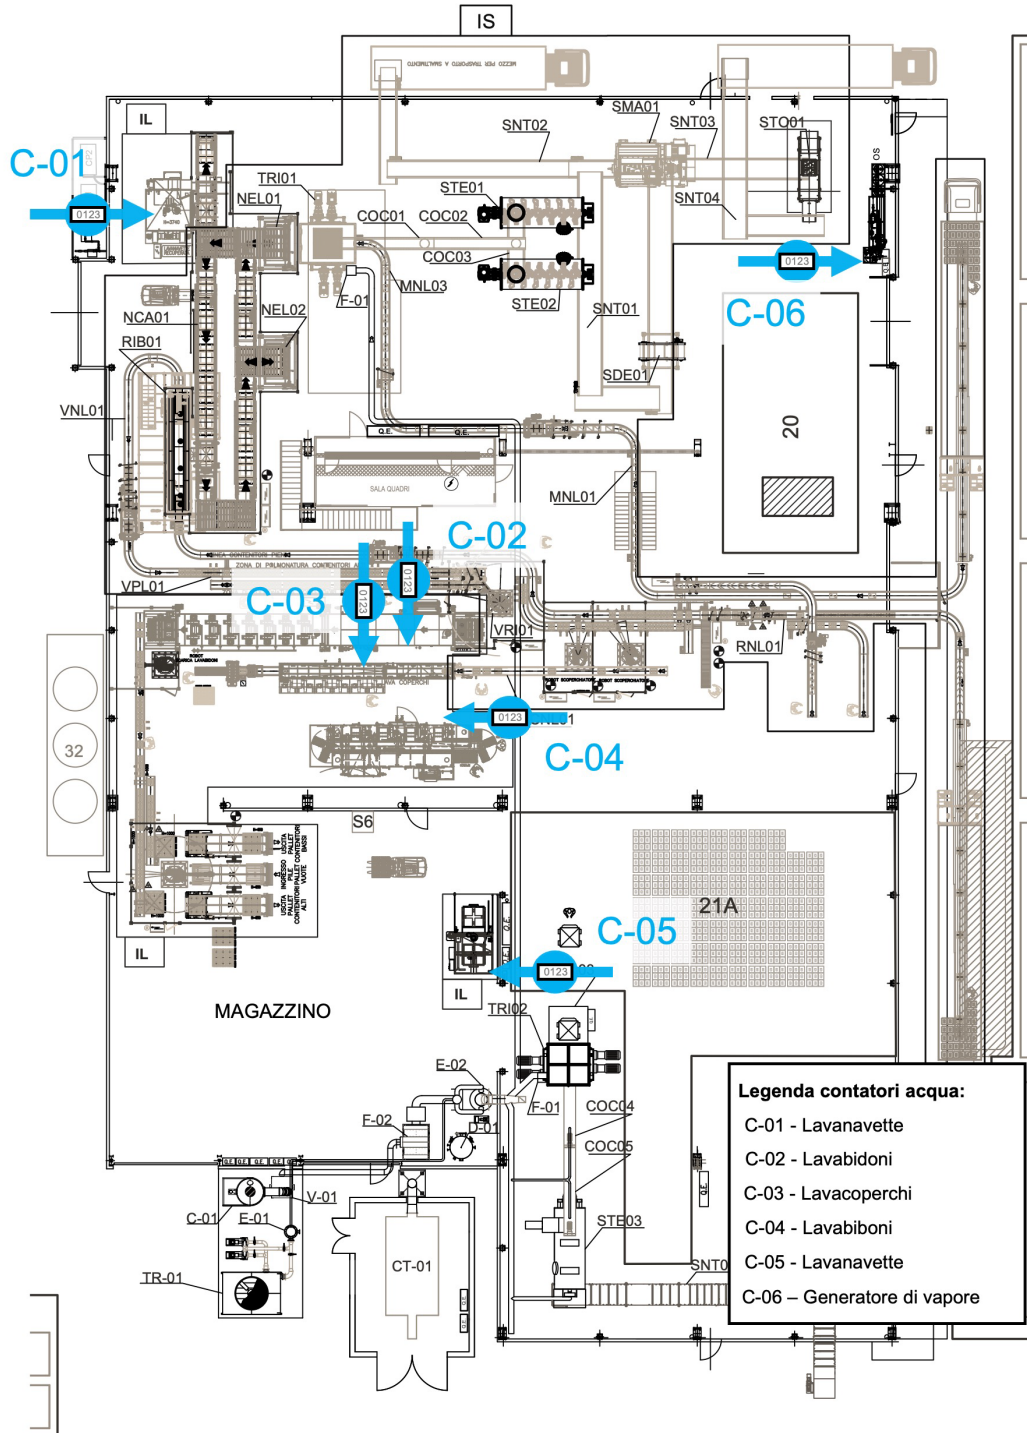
Planimetria del posizionamento dei contatori per le utenze idriche di impianto
